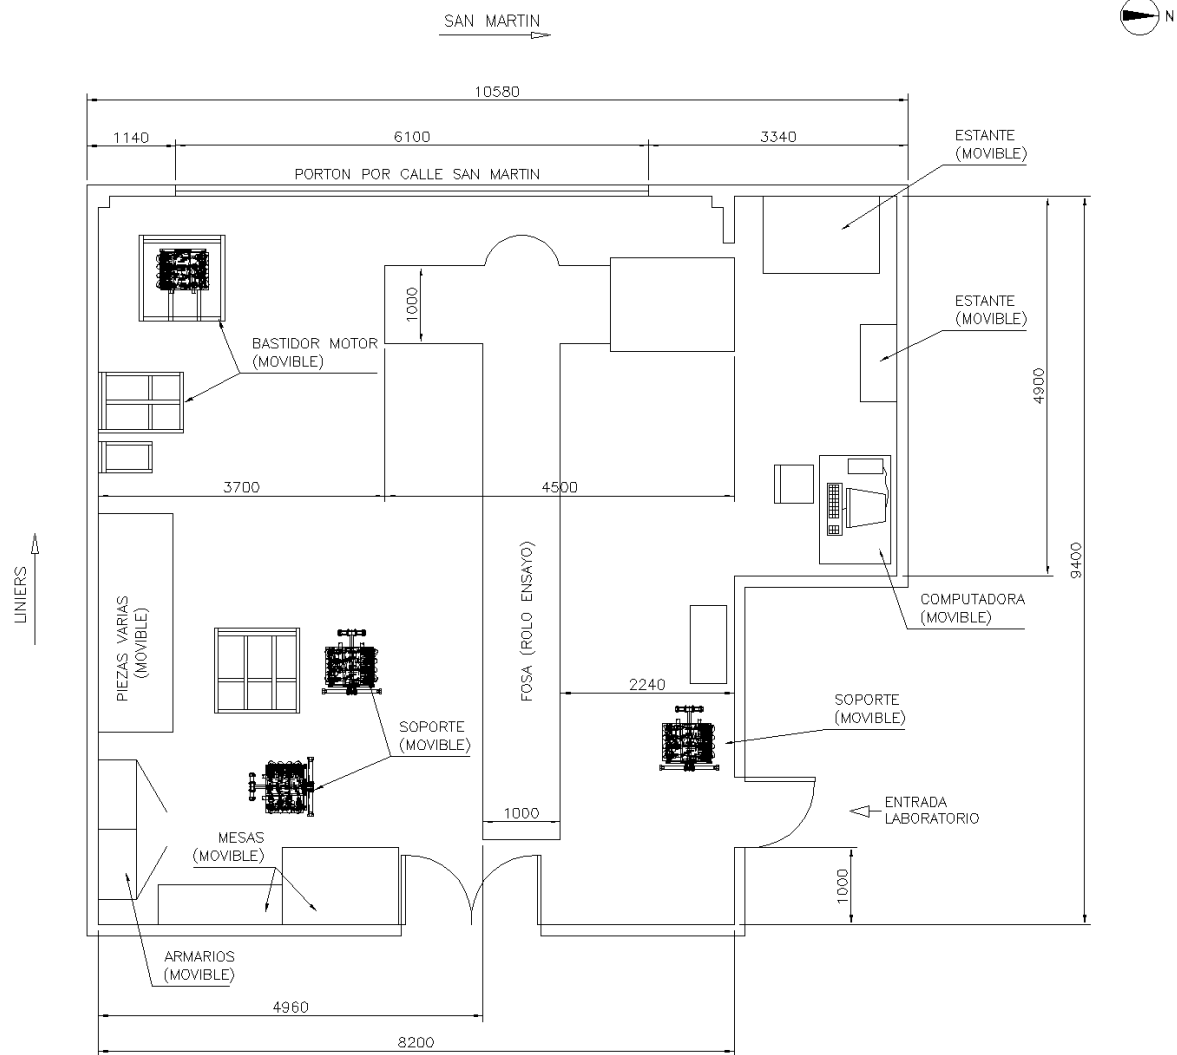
Dimensiones laboratorio – plano E2-02-01
